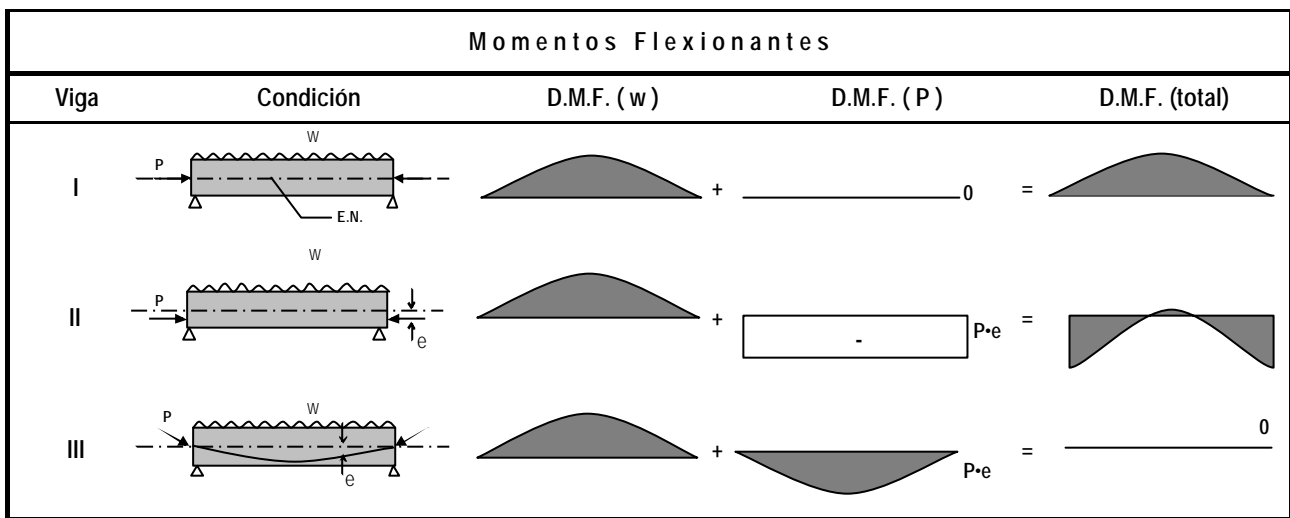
Momentos flexionantes a lo largo de vigas presforzadas simplemente apoyadas
